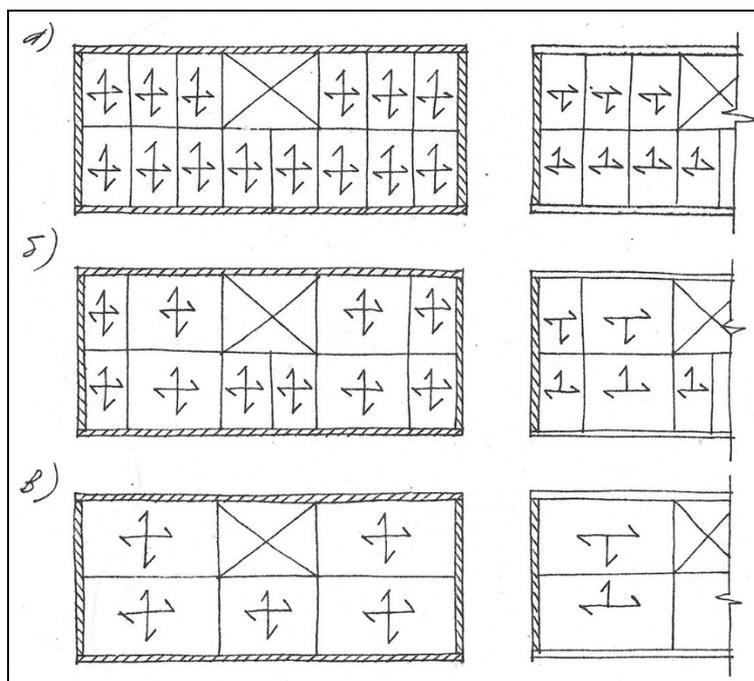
Перекрестно-стеновые конструктивные системы с перекрытиями: а – малопроелетными, б – среднепроелетными, в – крупнопроелетными; справа показаны случаи опирания плит перекрытий по трем сторонам
